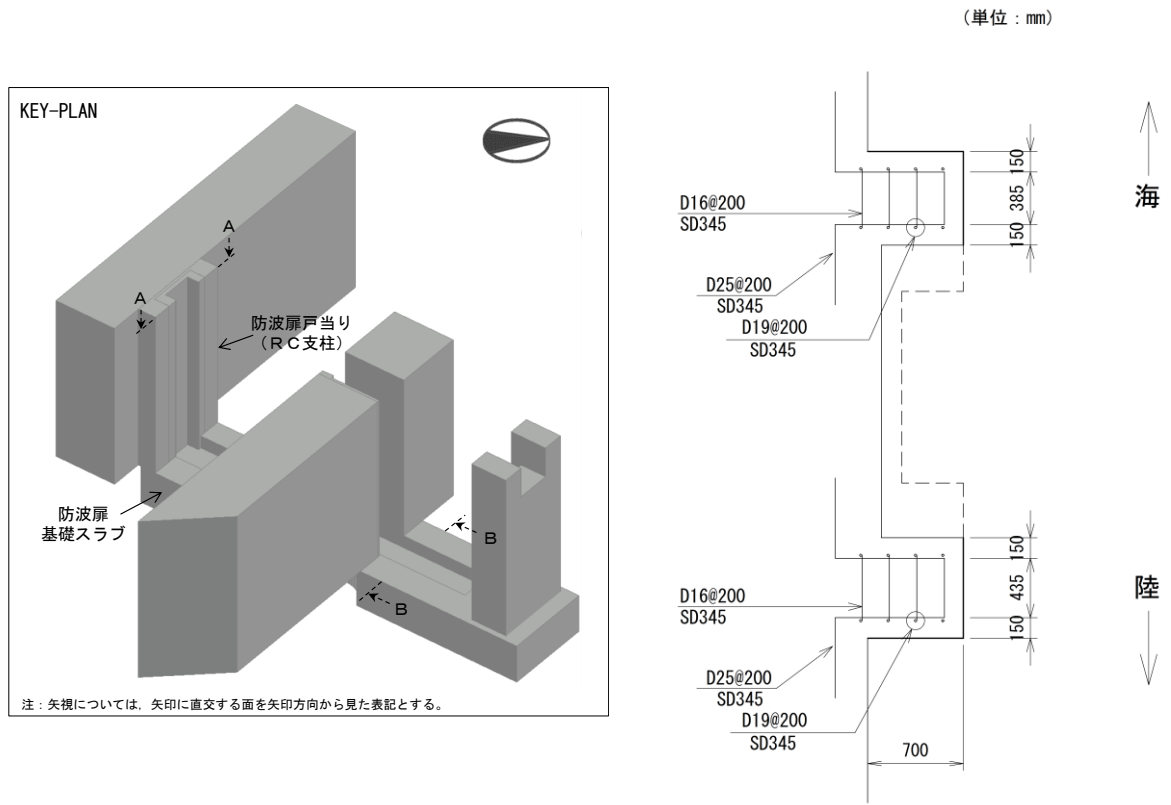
防波扉当り (RC 支柱) の概略配筋図 (A-A 断面)
